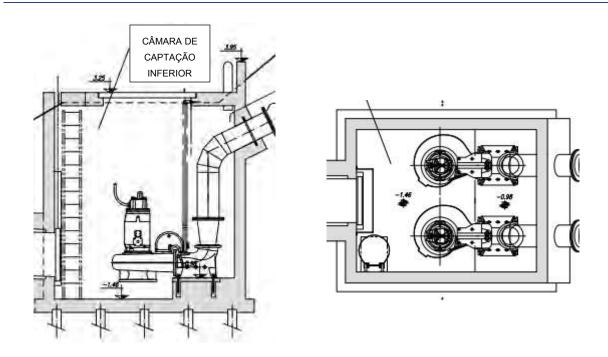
Solução tipo para a estação elevatória (corte à esquerda e planta à direita)
